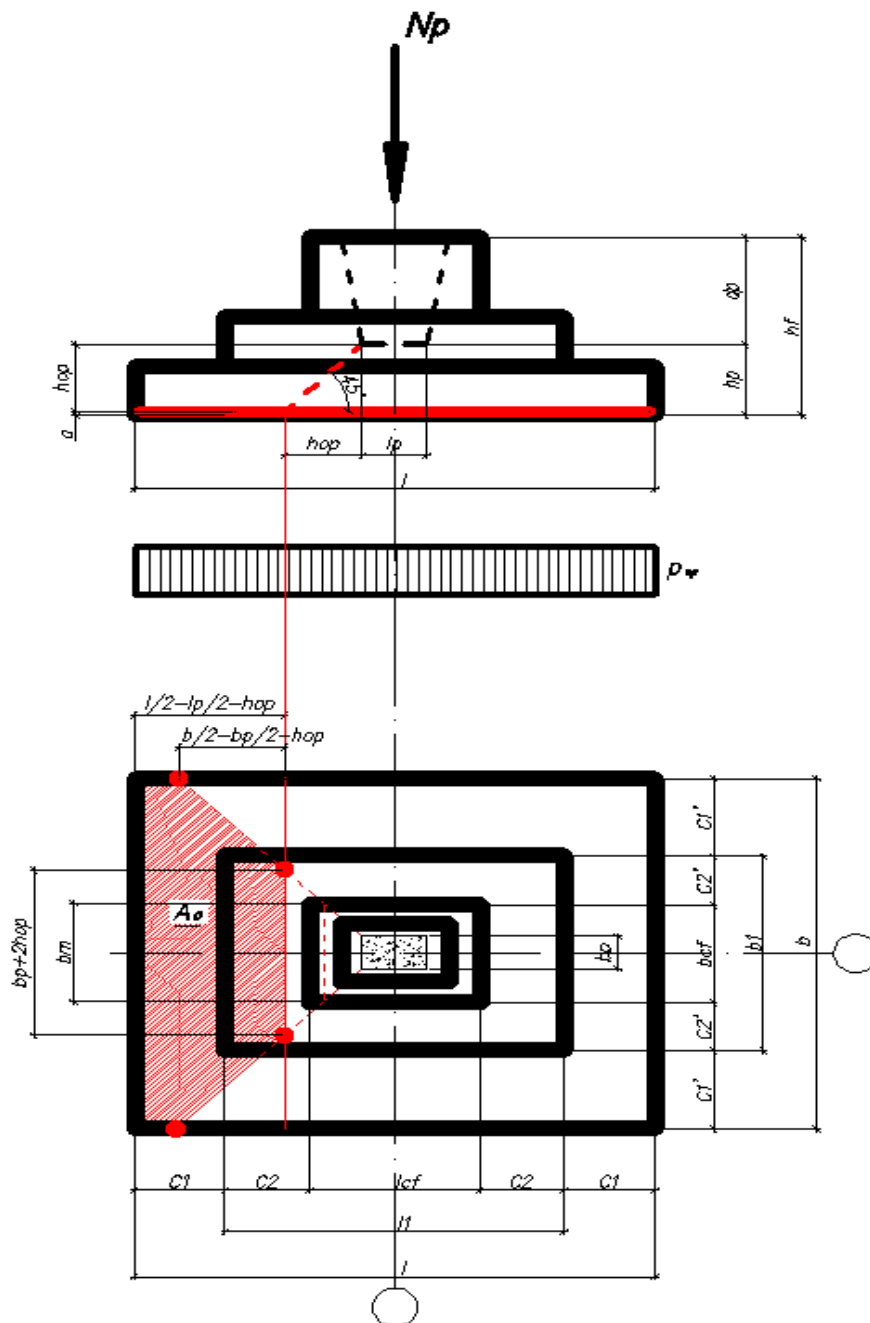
Схеми утворення піраміди продавлювання для фундаменту згідно з другою схемою
